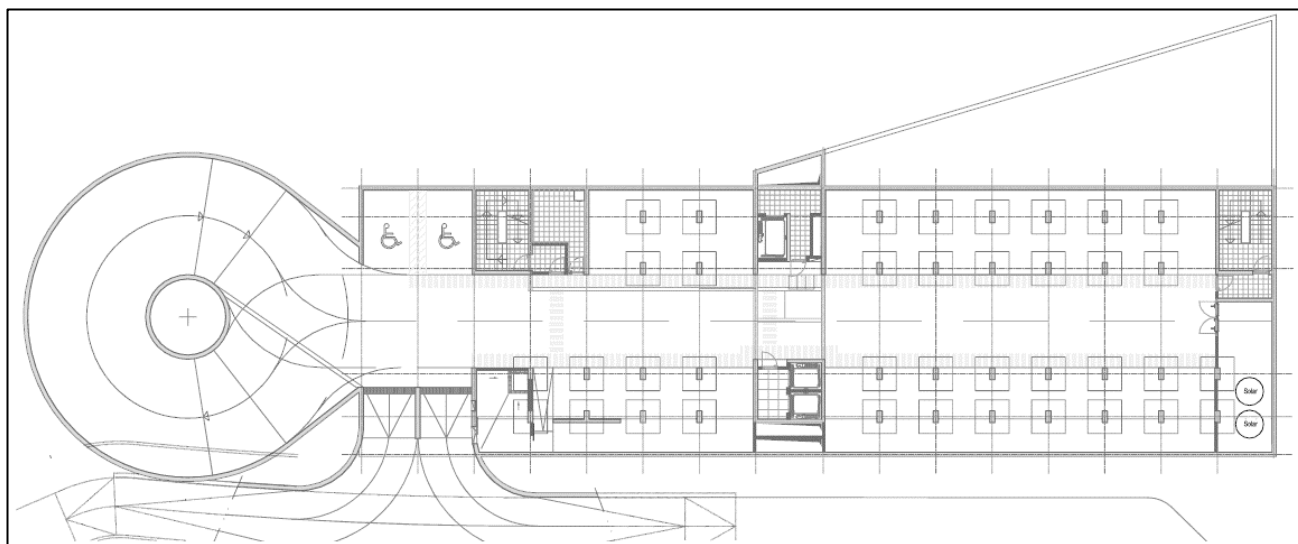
Planta do Caso de Estudo 4 – Hotel
